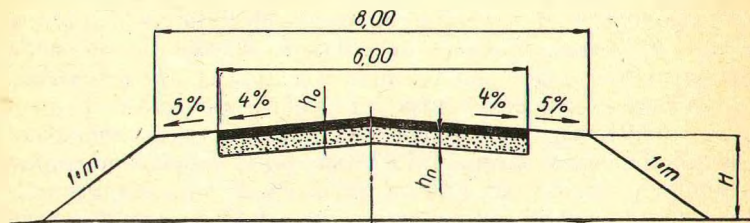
Поперечный профиль грунто-битумного покрытия на дороге Воничи — Галынка:
